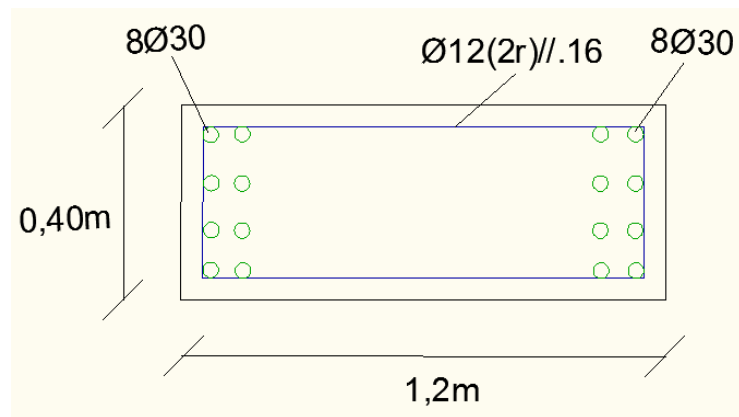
Secção transversal 3 de intersecção do pilar com a viga
